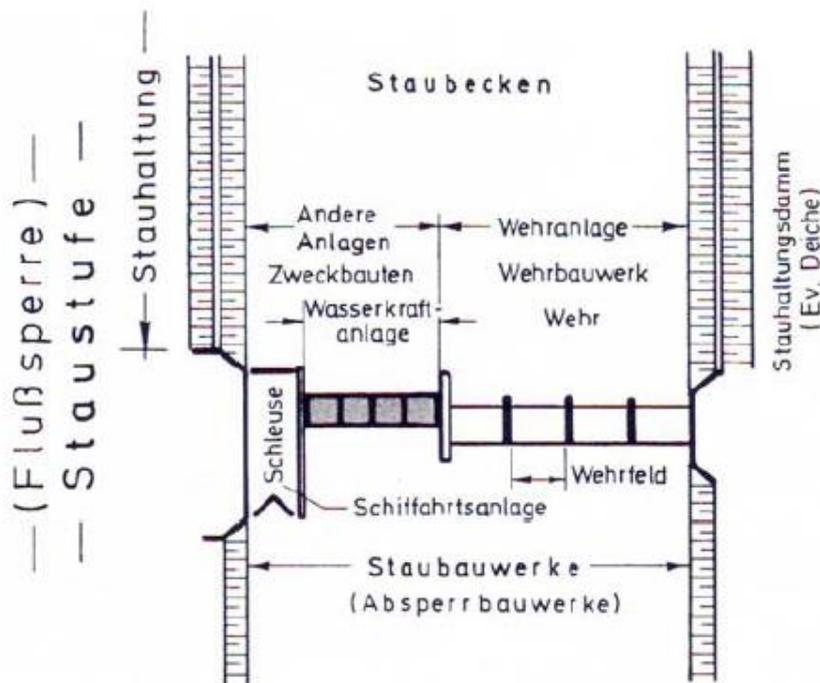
Schematische Darstellung einer Staustufe (Quelle:Blind 1987)
